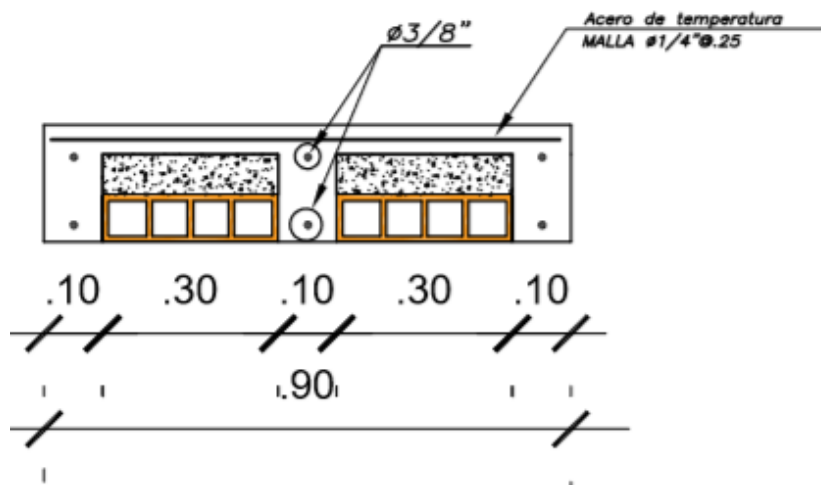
Vista en corte de losa aligerada con ladrillo compuesto con poliestireno (Fuente: Elaboración propia)
